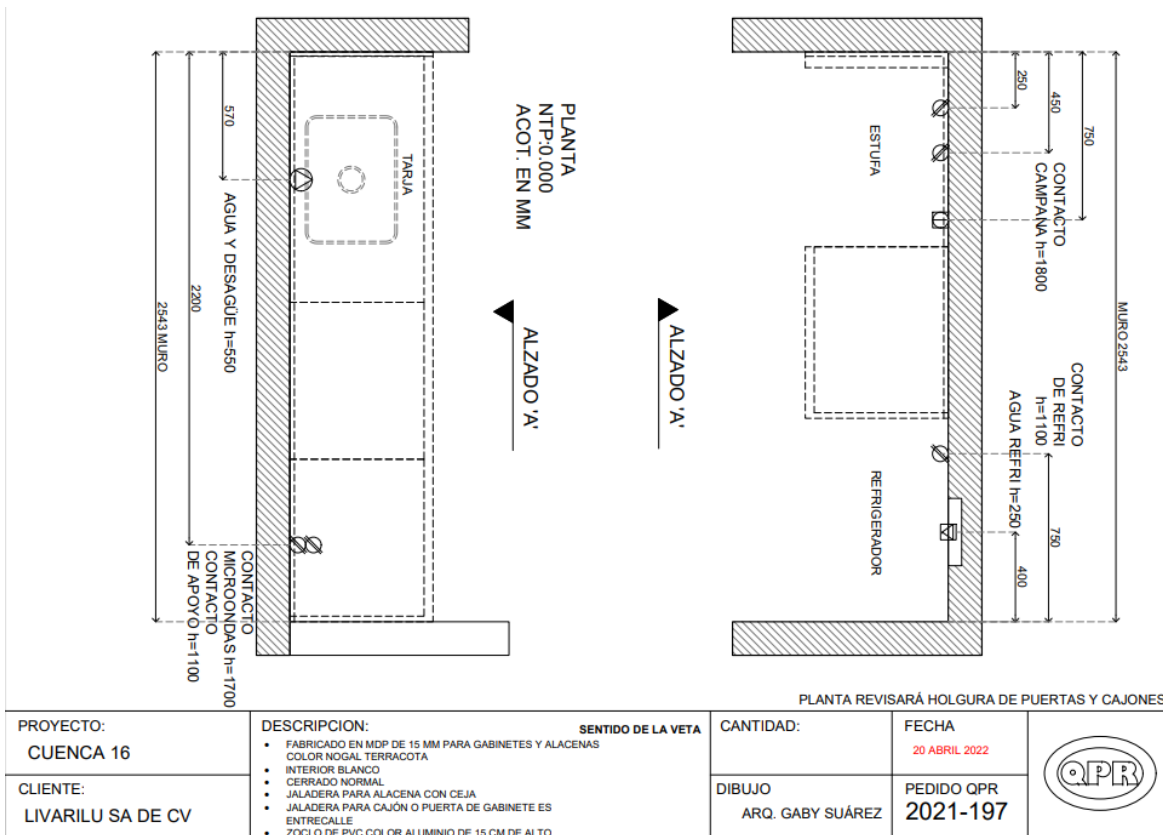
, 8b Croquis Cocina depto. Planta tipo 2021-197 (Cuenca 16 QPR)
